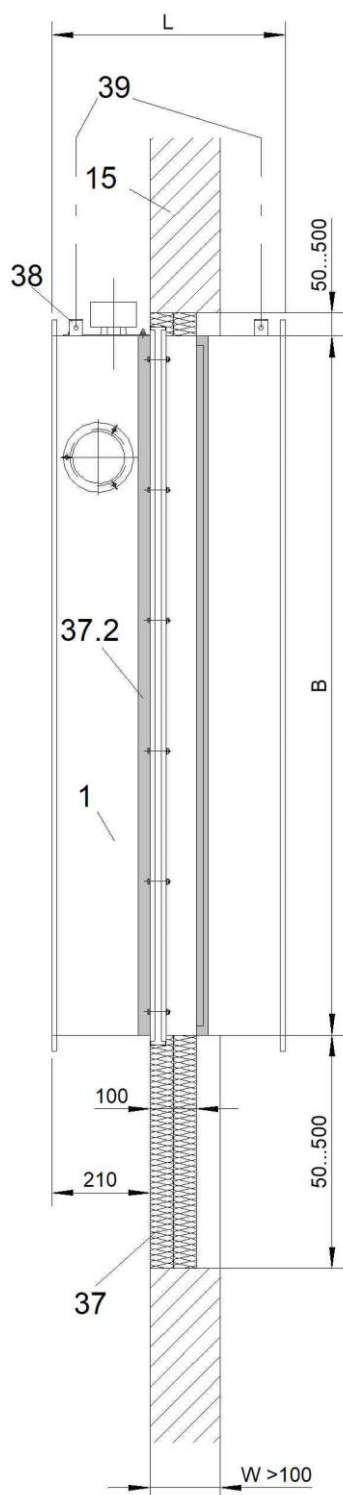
montaggio in parete massiccia (spessore parete > 100 mm)
